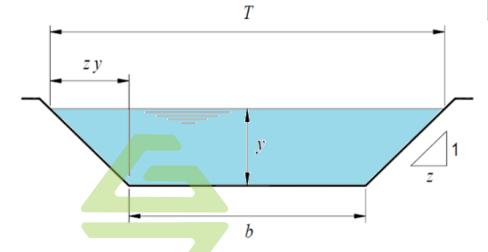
Elementos geométricos de la sección trapezoidal de un canal.
